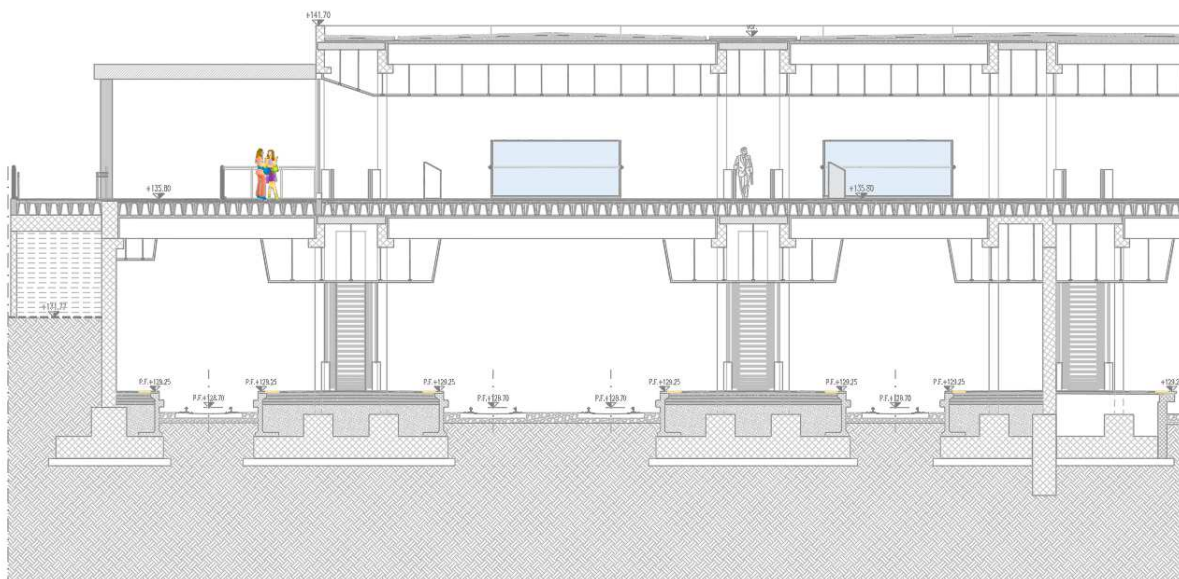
Sezione trasversale edificio con avancorpo ingresso ovest.
